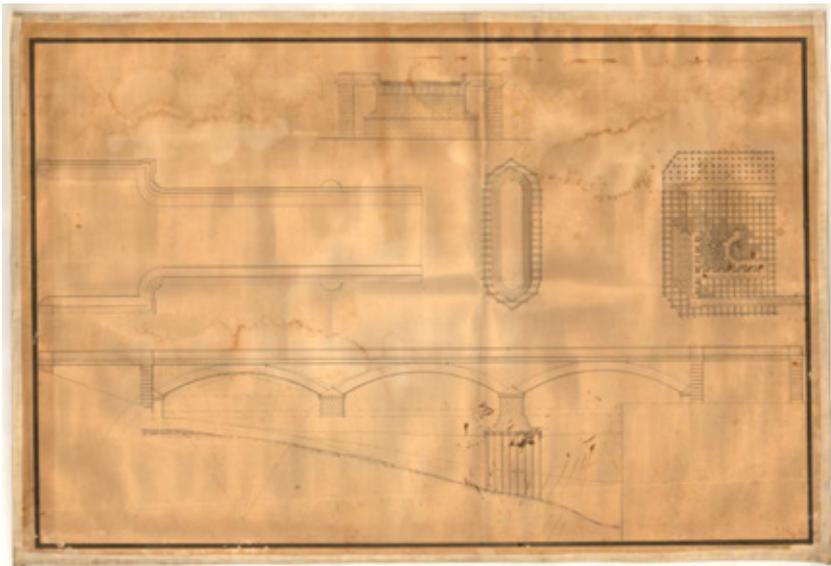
IHCM, CAGMM, CUB-45/11, Planta, vista y perfil del puente de Bailén, Carlos Benítez.
